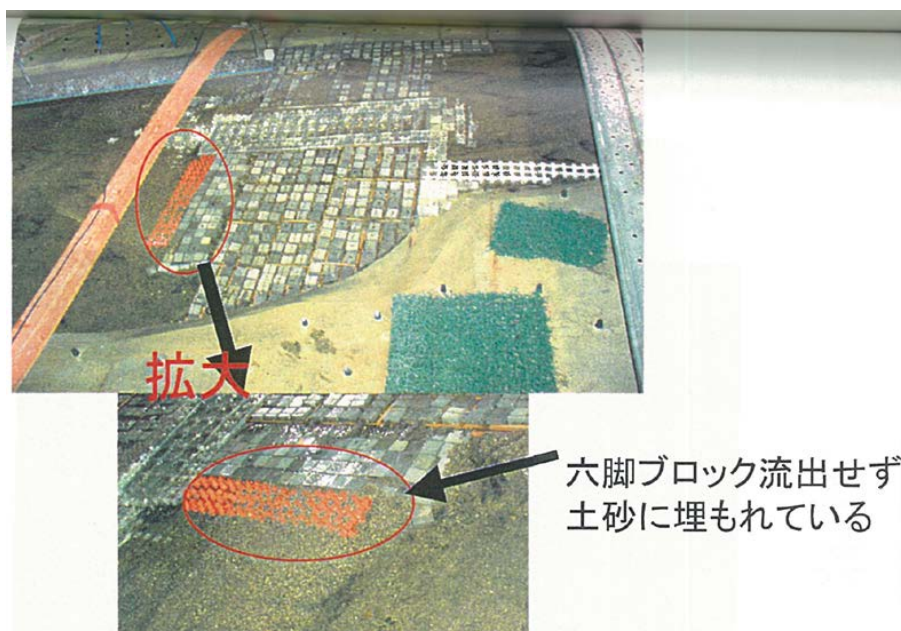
M床固工 左岸側六脚ブロック護床工通水後土砂堆積
